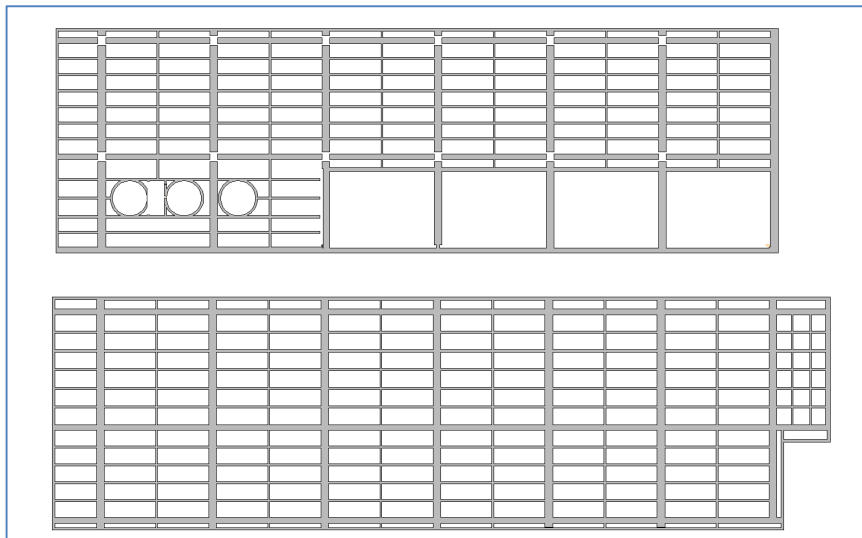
Volúmenes de placas en concreto (vigas viguetas y placas macizas).
